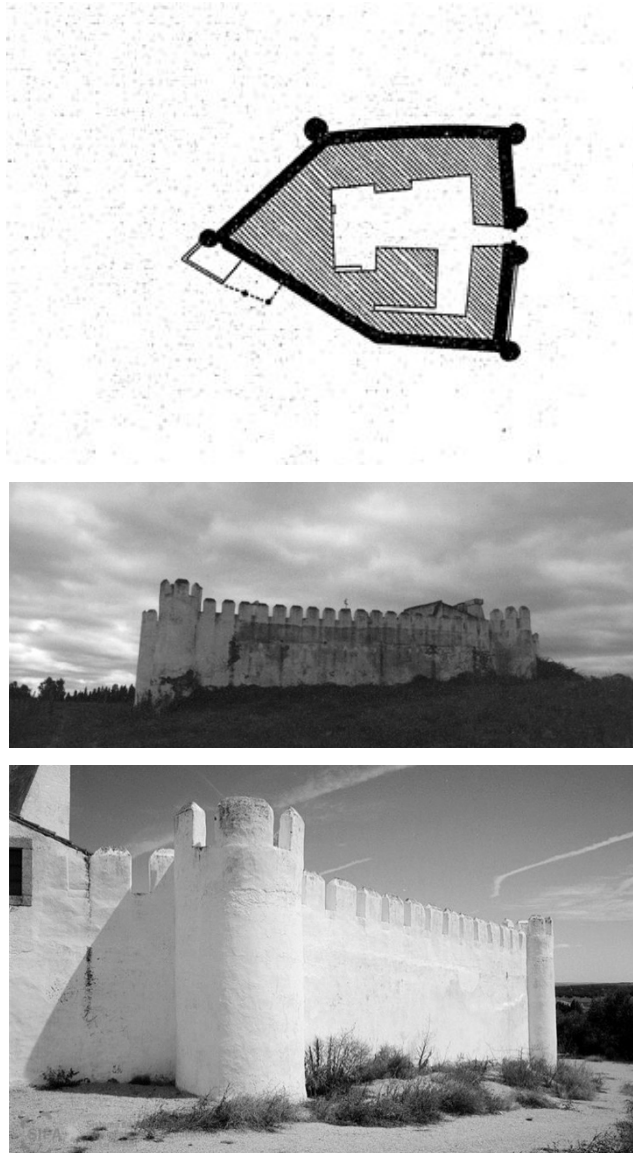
| Castelo de Fontalva (arredores de Elvas). Planta e vistas gerais exteriores (seg. DGEMN/IHRU)
